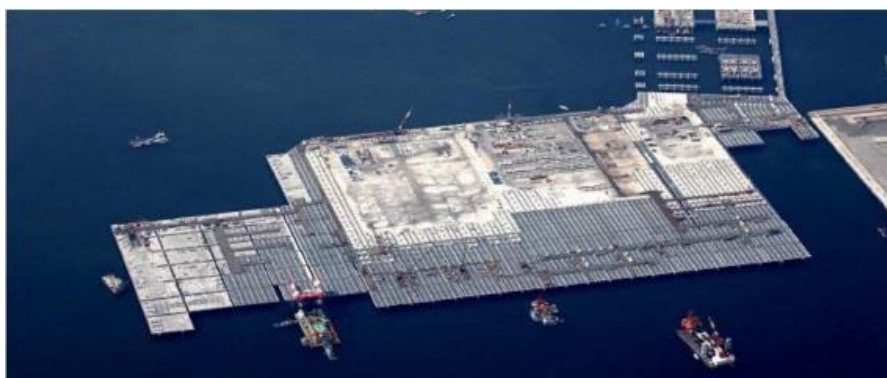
Vista aérea da construção da estrutura do aeroporto de Haneda, Japão
